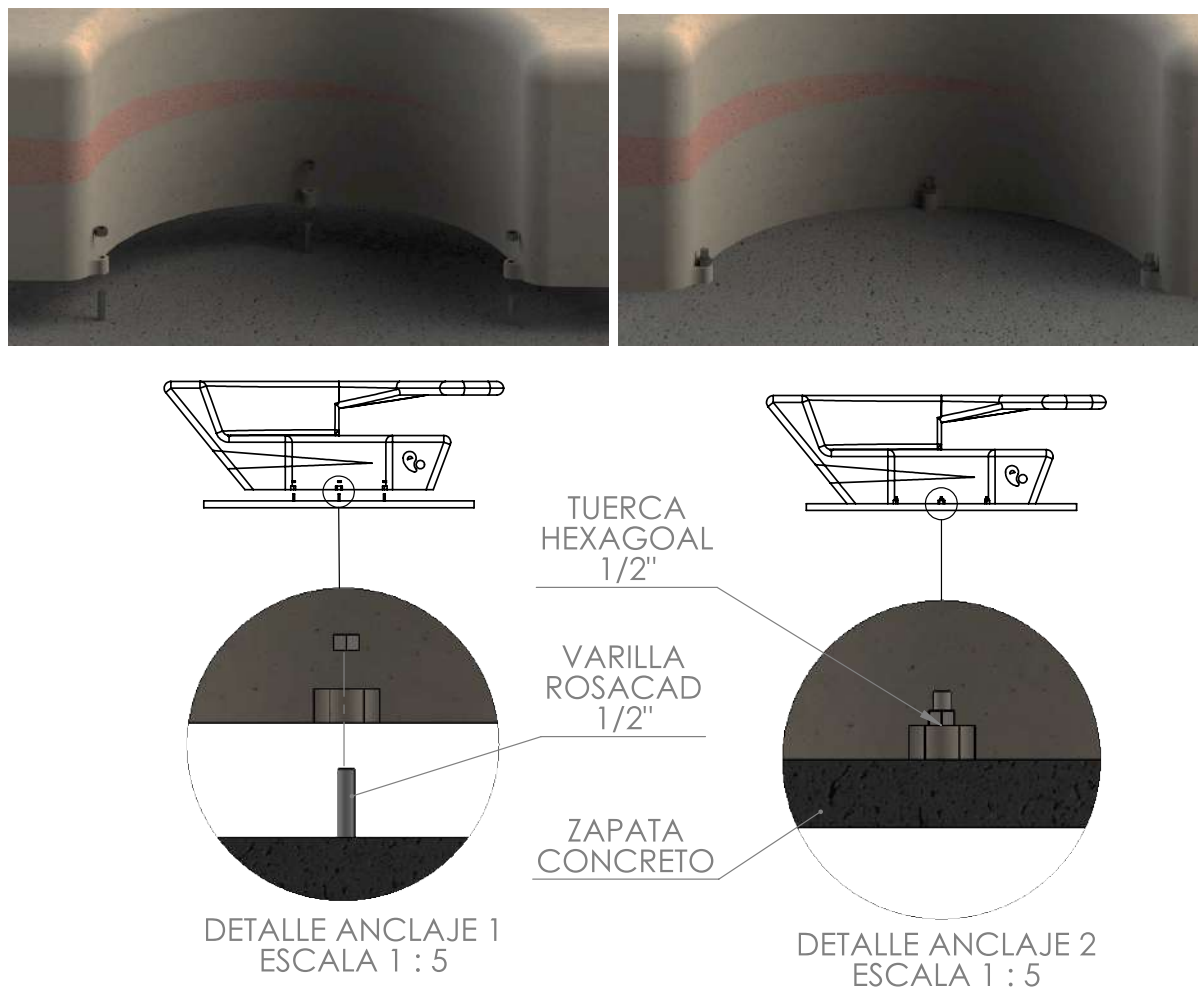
Detalle sistema de anclaje del elemento a la zapata. Fuente propia.
